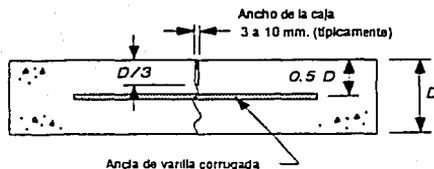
JUNTA LONGITUDINAL DE CONTRACCIÓN.
